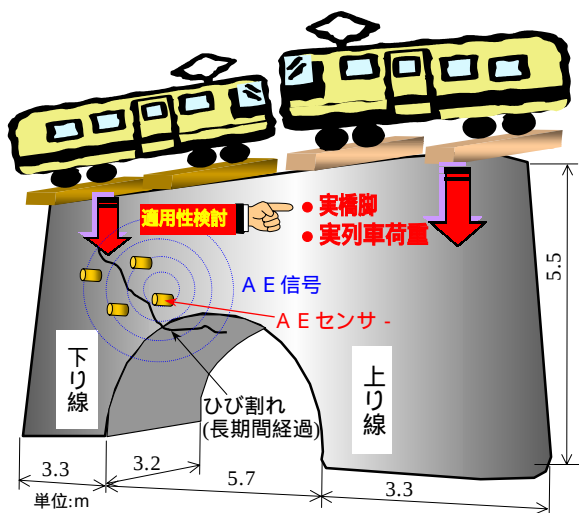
既存のひび割れのある橋脚および AE 計測模式図
